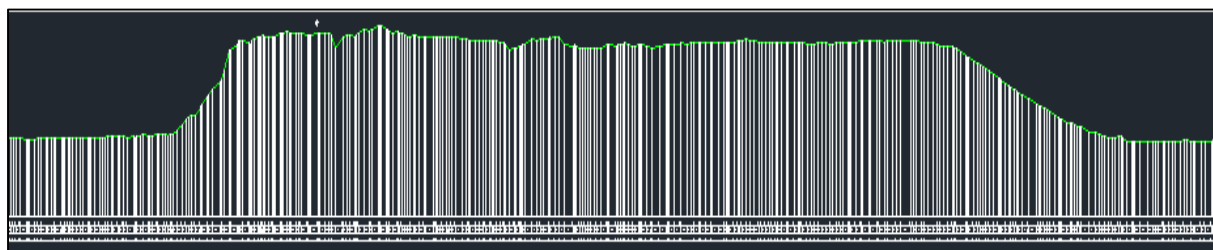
Profil en travers 122 - remblai de la voie ferrée
